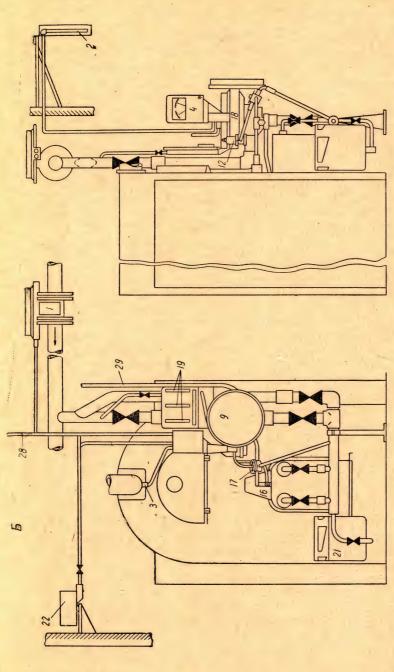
Комплексная автоматика для водонагревательных котлов, оборудованных инжекционными горелками низкого давления (А — схема; Б — установка приборов):
